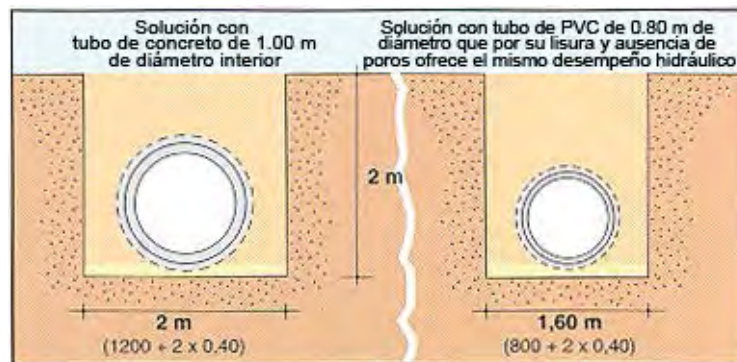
DISMINUCIÓN DE TRABAJOS DE TERRACERÍA
